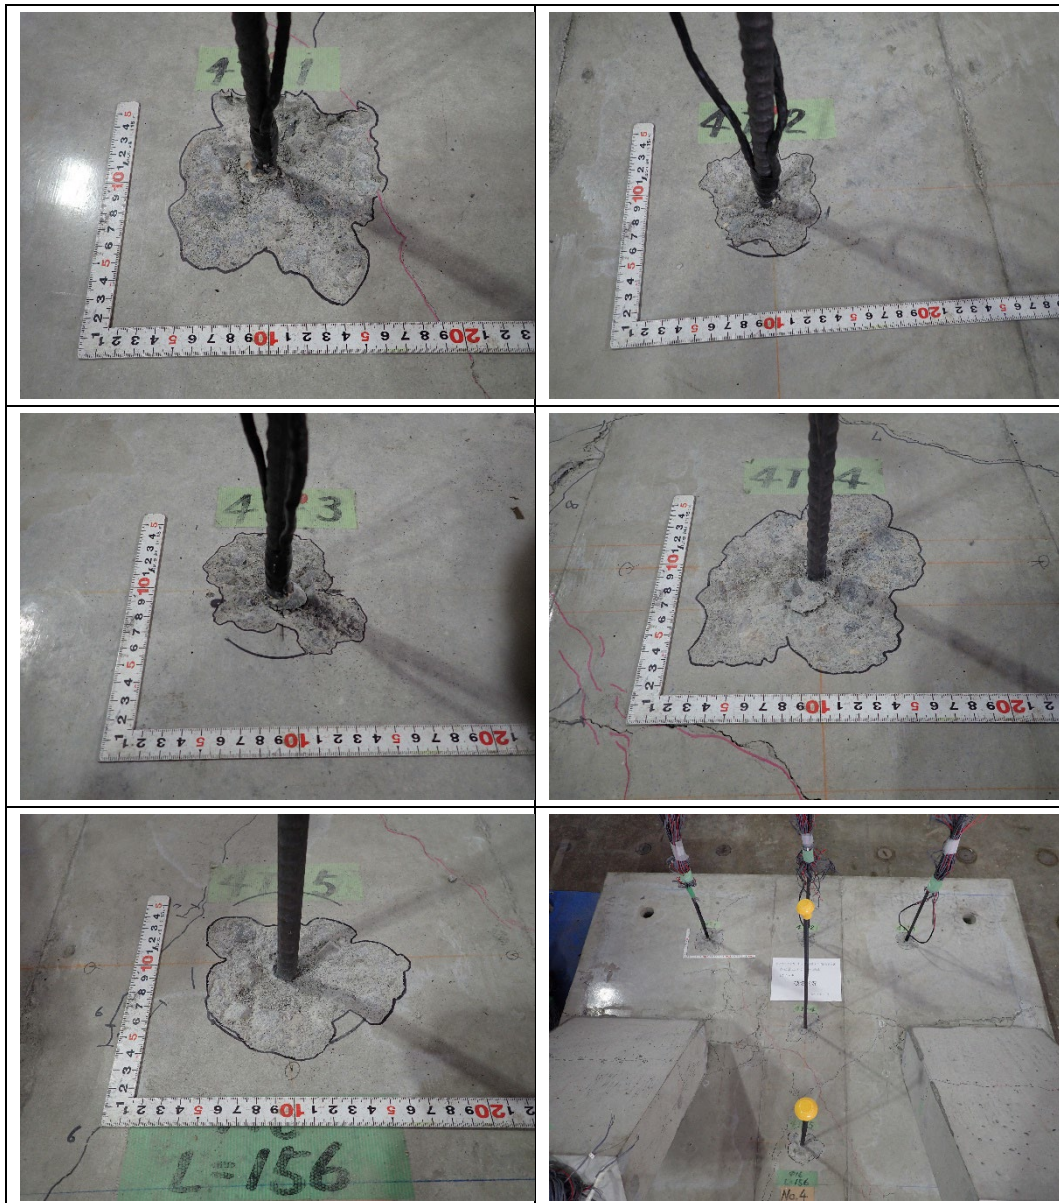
あと施工アンカー単体実験破壊状況 (4T-1～4T-5)
